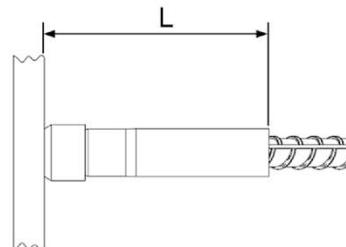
Gesamtlänge der Griptec Schweißverbindung (WC)
